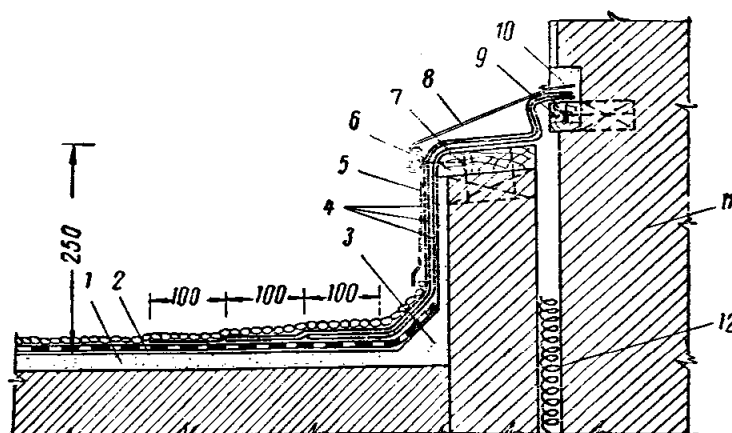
Примыкание кровли из рулонных материалов к температурно-осадочному шву у стены
